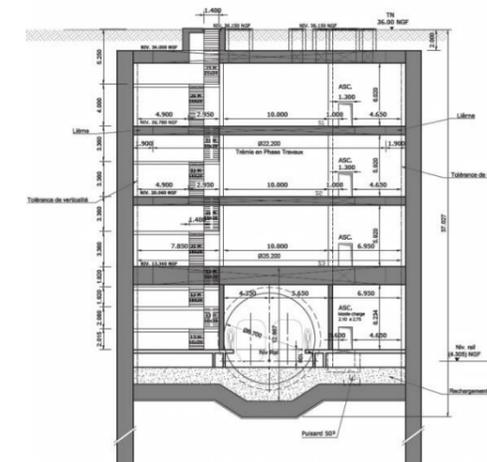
Coupe - Vue en plan niveau Tunnel - Vue en plan Niveau TN OS 1302P
